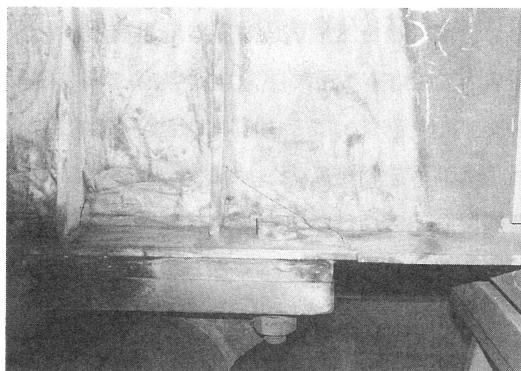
箱桁ソールプレート溶接部における疲労損傷事例
